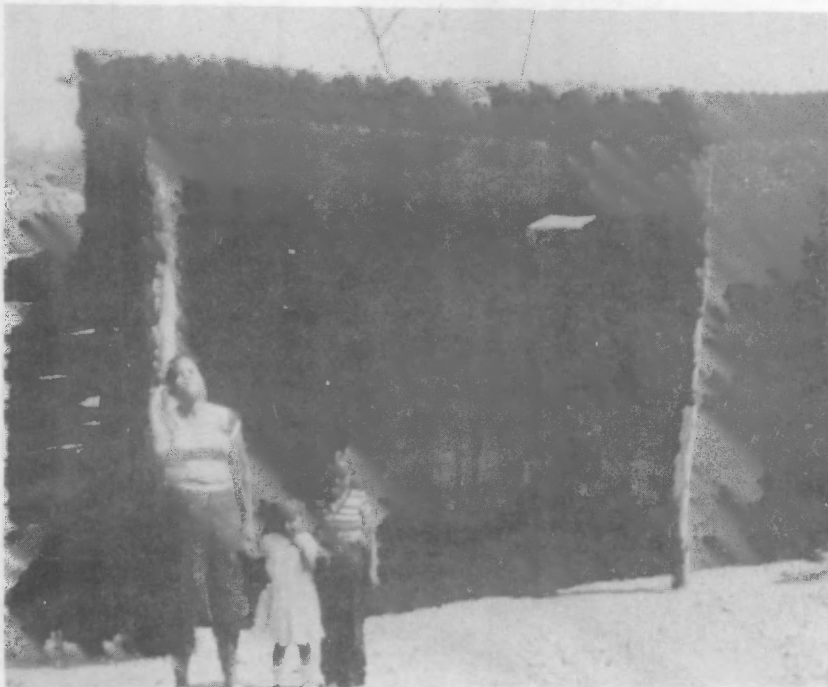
Vivienda tipo 5. Aldea El Llano, Jalpataqua, Jutiapa.
